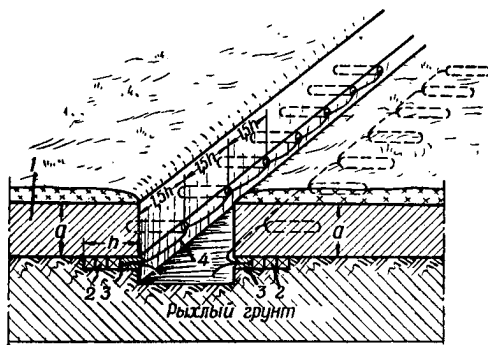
Схема расположения горизонтальных шпуров с предварительной разработкой узкой полосы мерзлого грунта:
